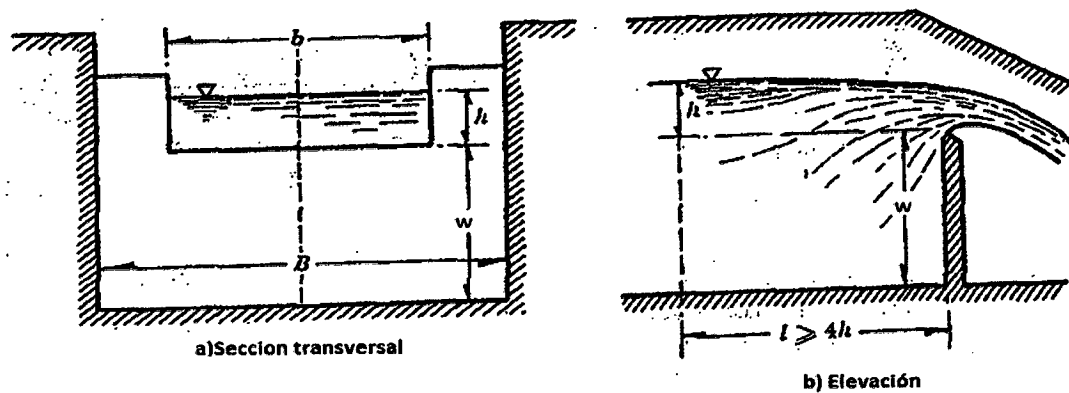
Vertedor rectangular (sección transversal y elevación)
